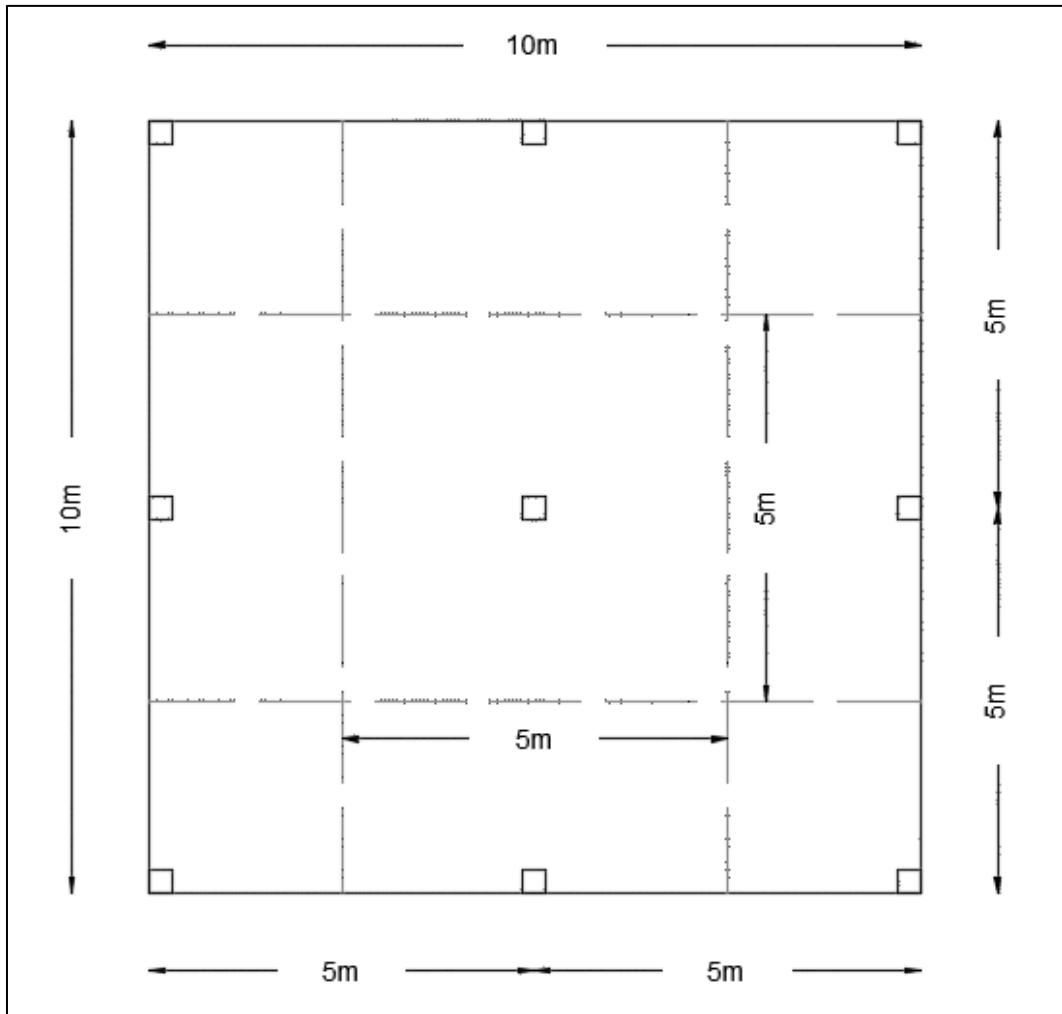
Ejemplo de cálculo, áreas de aporte de cargas a las columnas.
